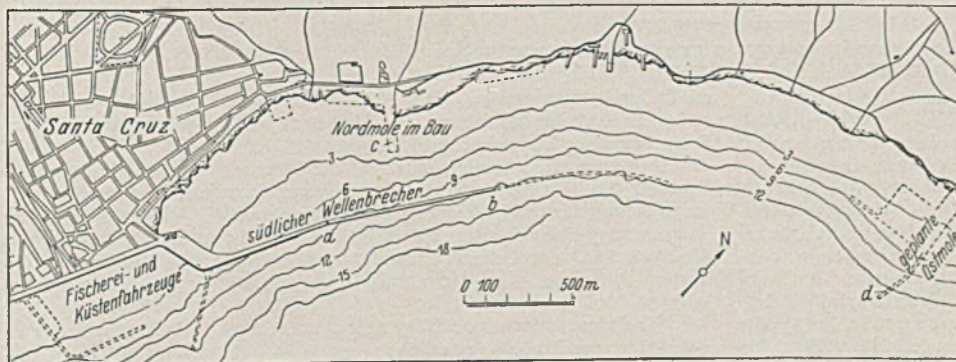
Gesamtplan des Hafens von Santa Cruz auf Teneriffa.
